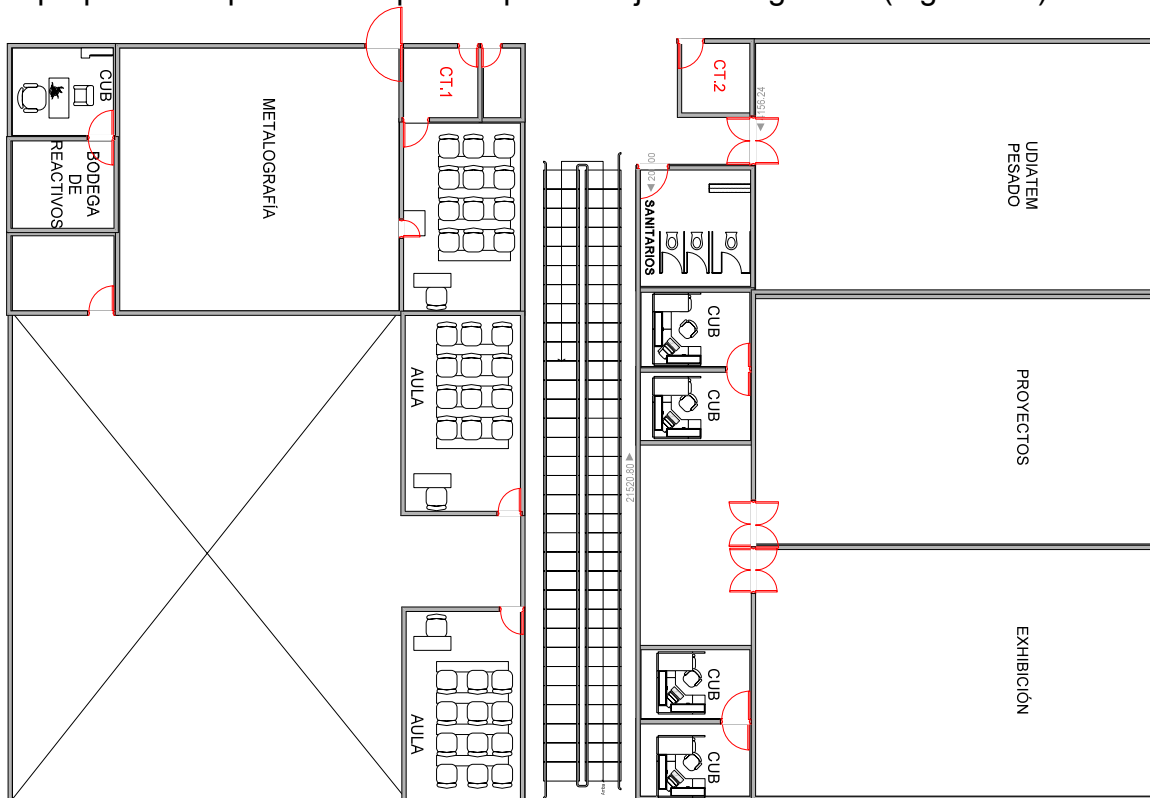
Propuesta arquitectónica Planta Baja CIA
